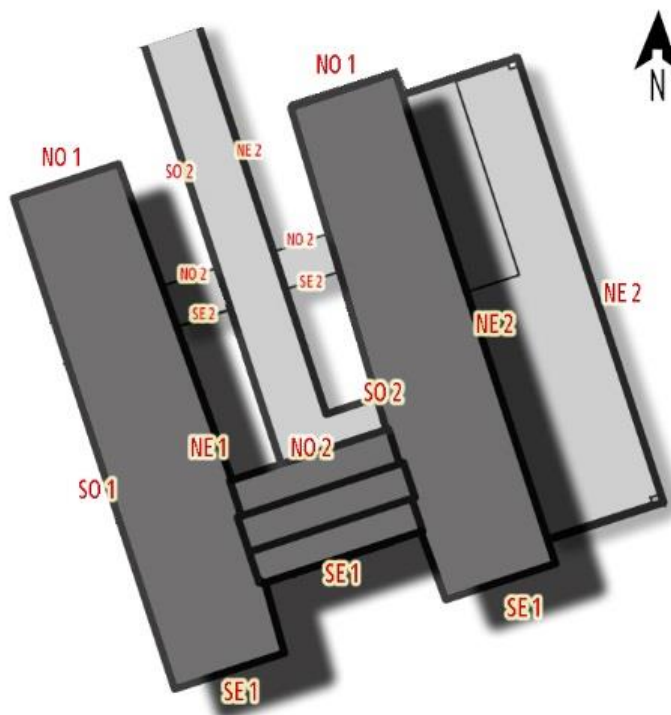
Nomenclatura de fachadas de acuerdo con su orientación
